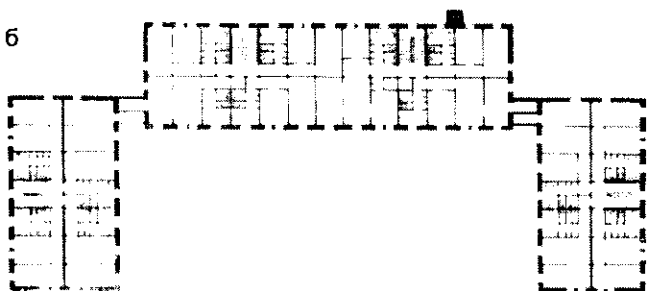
Бескаркасный крупнопанельный 5–7 этажный жилой дом в Москве
